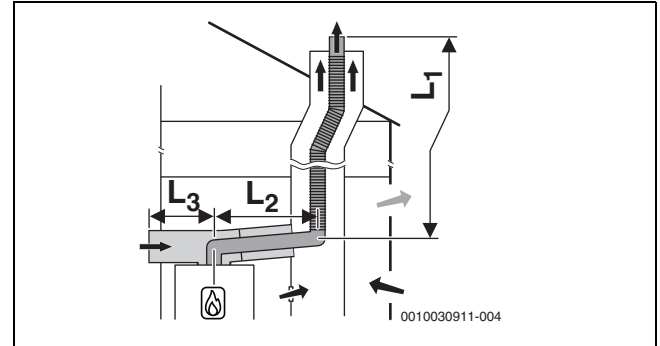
Flexible Abgasführung nach  $C_{53x}$  im Schacht und Luft-Abgas-Führung mit separater Luftzufuhr und konzentrischer Abgasab-
